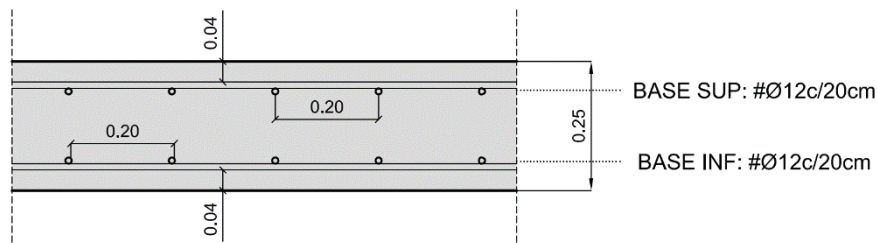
Sección de losa maciza de 25 cm de canto. Fuente: David Gallardo.
